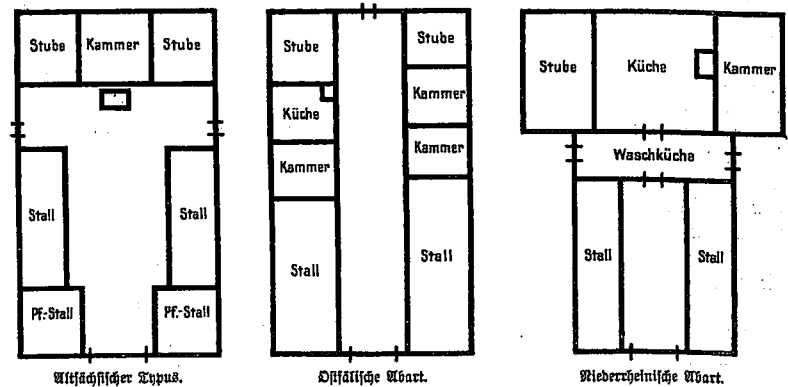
Grundrisse des niederdeutschen Bauernhauses. (Nach Dr. W. Pfeiler.)
